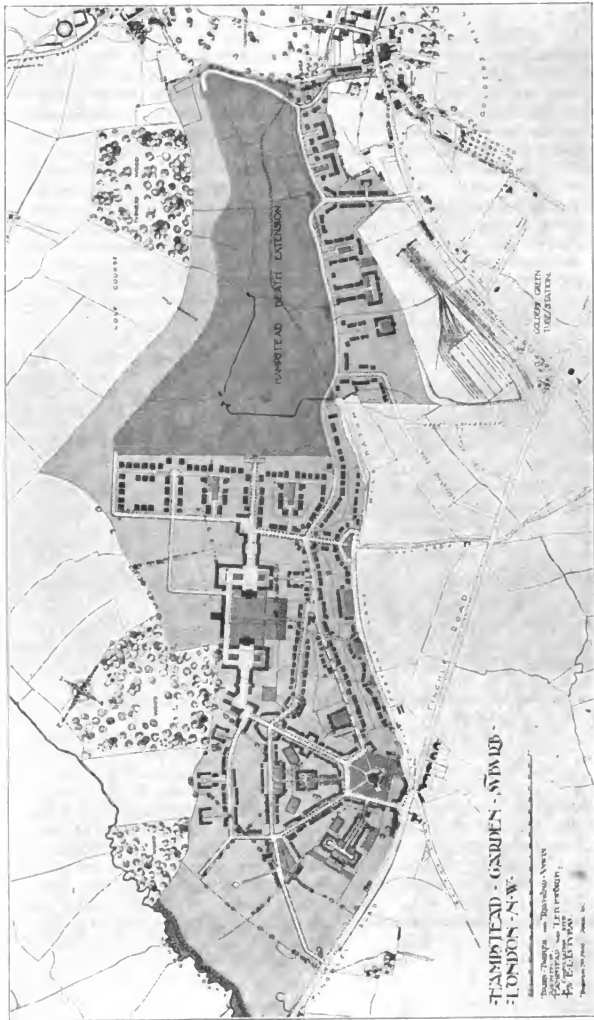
Bebauungsplan der Gartenvorstadt Hampstead-London.
